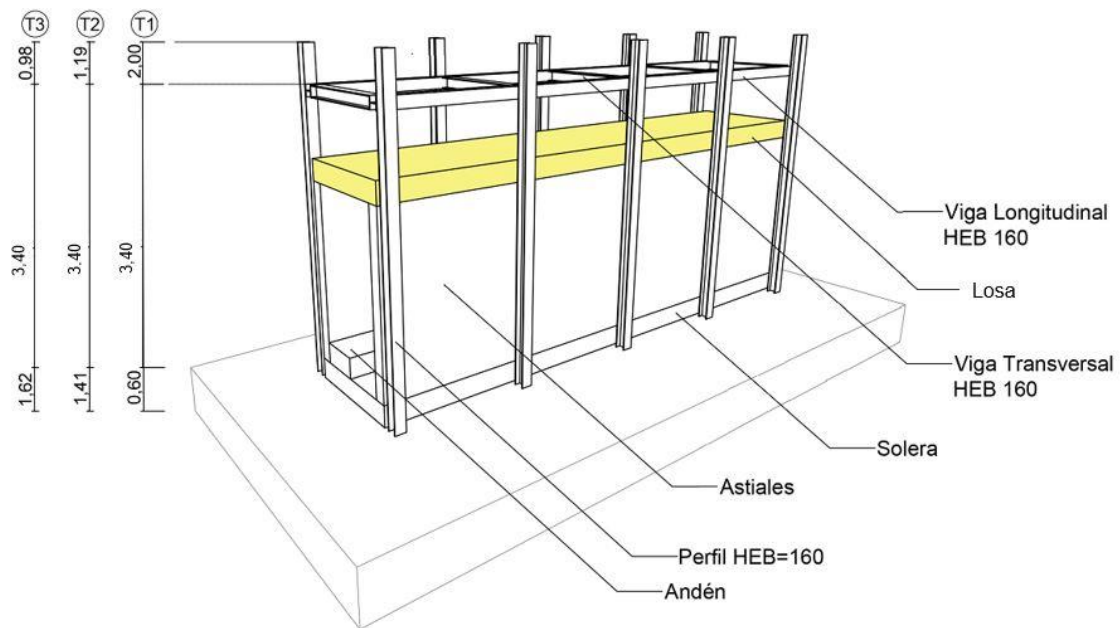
D7-Hormigonado losa en sección de tramo 1-2-3
